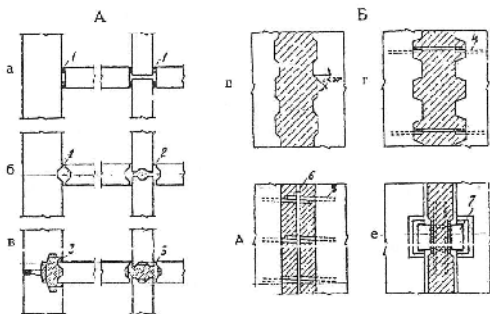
Вертикальные стыки панелей стен: А – в плане; Б – в фасаде; а – плоские; б – профилированные бесшпоночные; в – профилированные с бетонными шпонками; г – шпоночные с замоноличенными стальными связями; д – с вертикальным армированием по горизонтальным петлевым выпускам; е – со стальными замоноличенными шпонками; 1 – звукоизоляционная прокладка; 2 – растзор; 3 – бетон замоноличивания; 4 – сварная арматурная связь; 5 – петлевой выпуск; 6 – вертикальная арматура; 7 – стальные накладки, приваренные к закладным деталям
